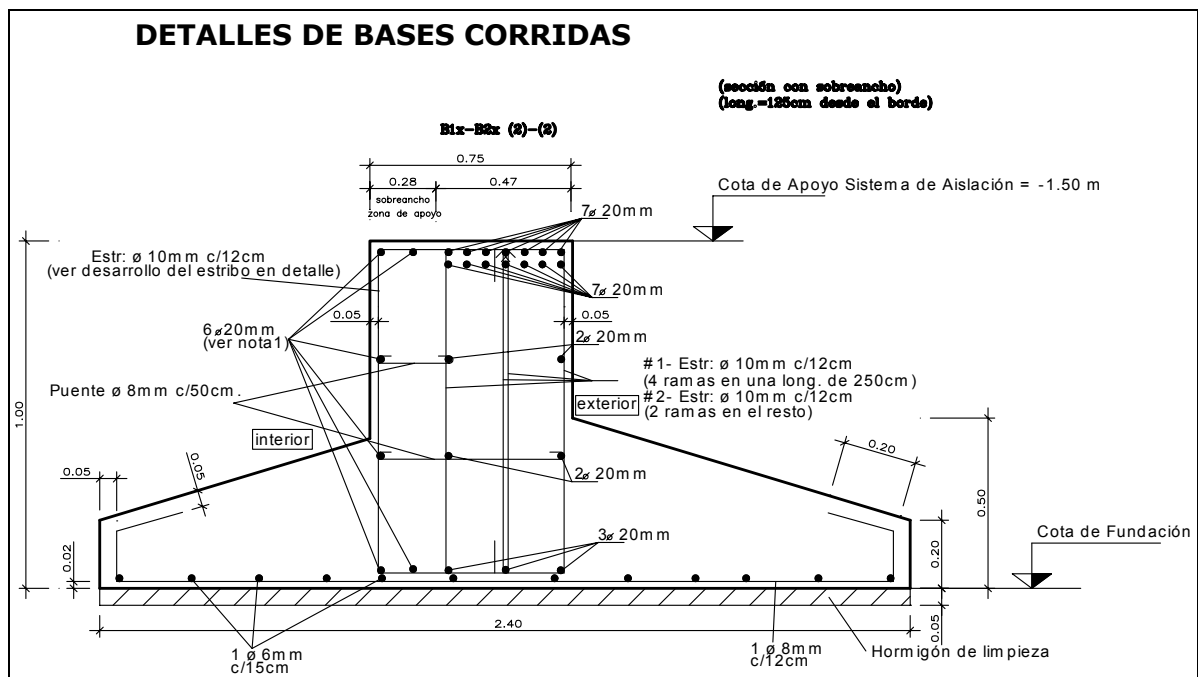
c: Detalle de base corrida utilizada como estructura de fundación en la torre con aislamiento sísmico (Sección donde se emplaza el sistema de aislamiento)
